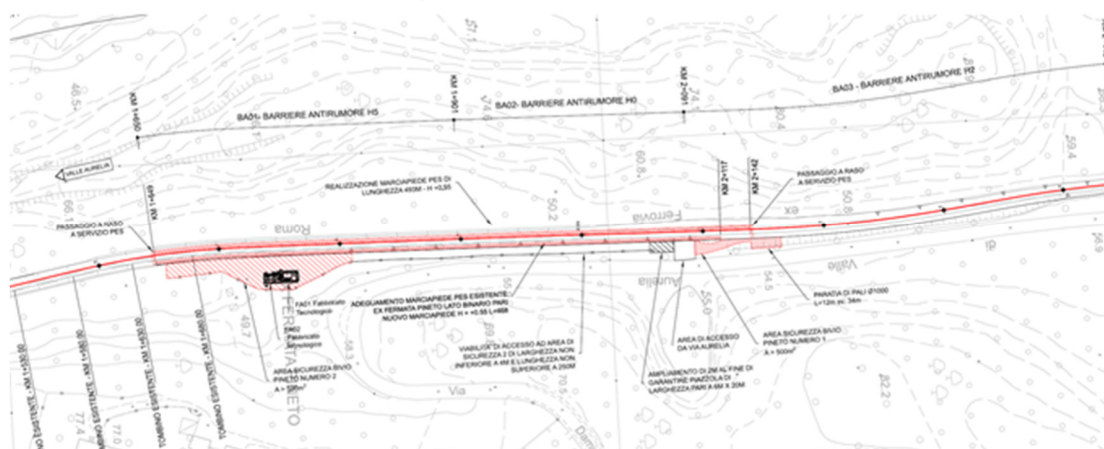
Stralcio planimetrico zona PES bivio Pineto
